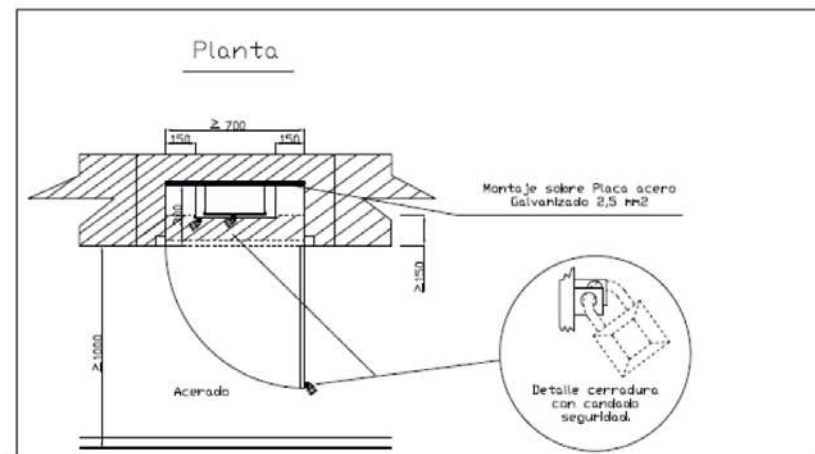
Instalación CGP y CS montaje vertical. Planta.
